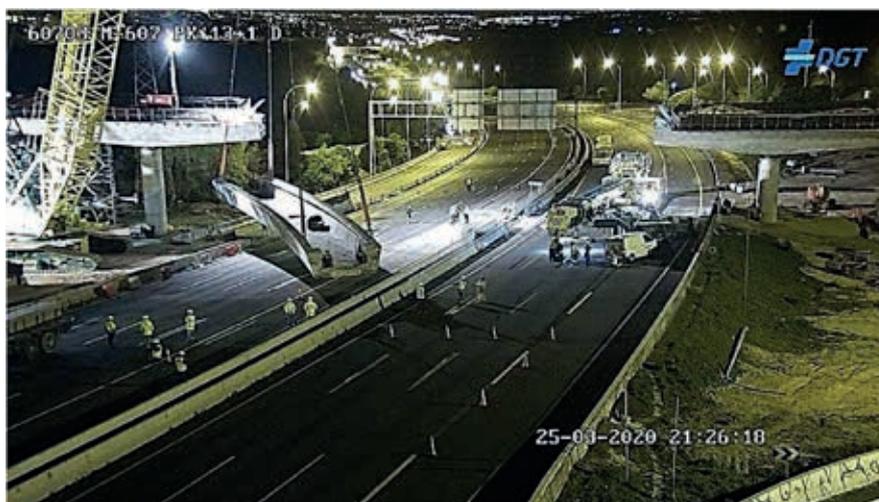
Montaje del nuevo tablero sobre las calzadas de la M-40
